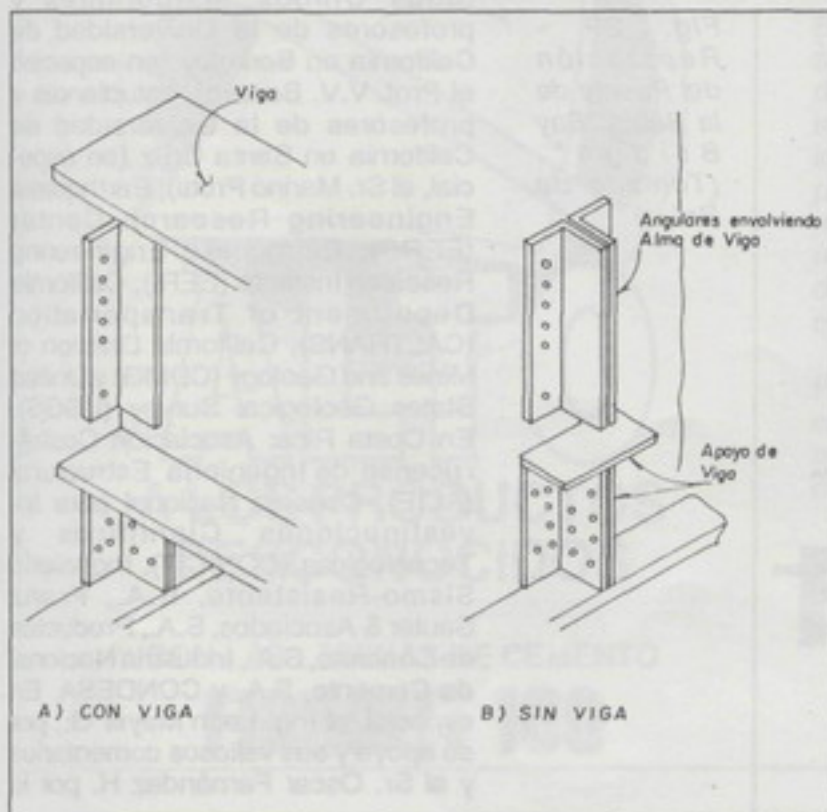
Apoyo de viga en tramo colapsado del Puente de la Bahía "Bay Bridge". Tomado de Ref. 1)
